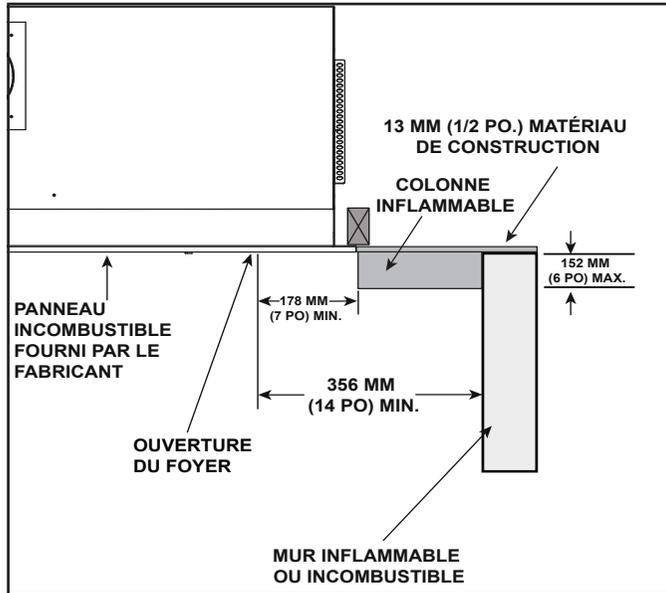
Saillies inflammables des pieds du manteau de foyer et du mur
